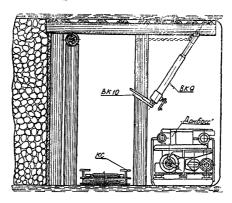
Схема установки стойки ВК-9 для поддержания консоли верхняка
